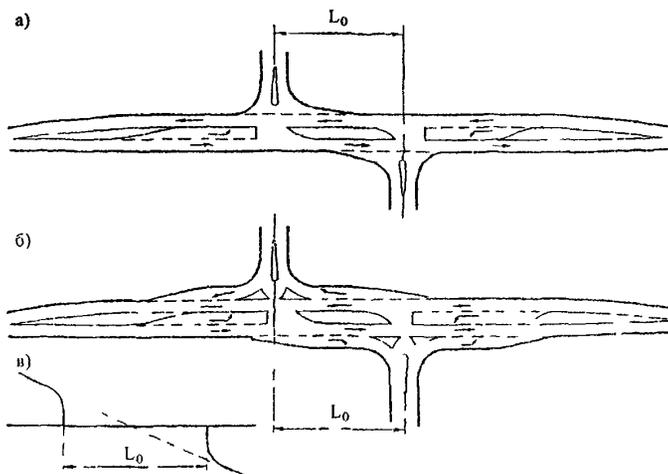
Перестройка пересечения на два смещенных примыкания:
